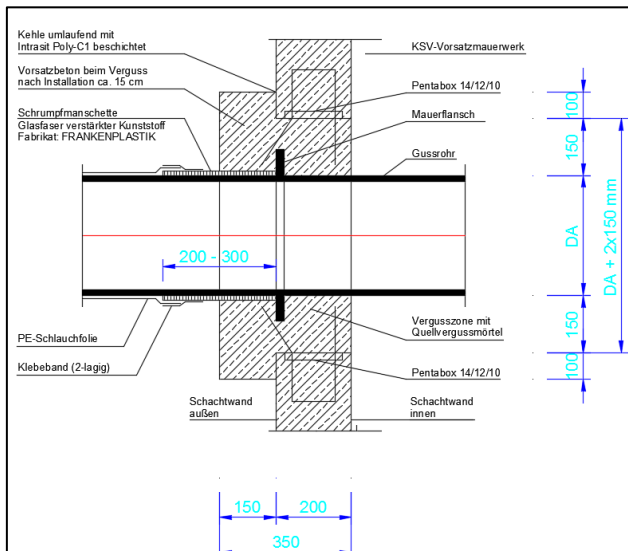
Detail – Mauerdurchführung (FWF, 2016)
